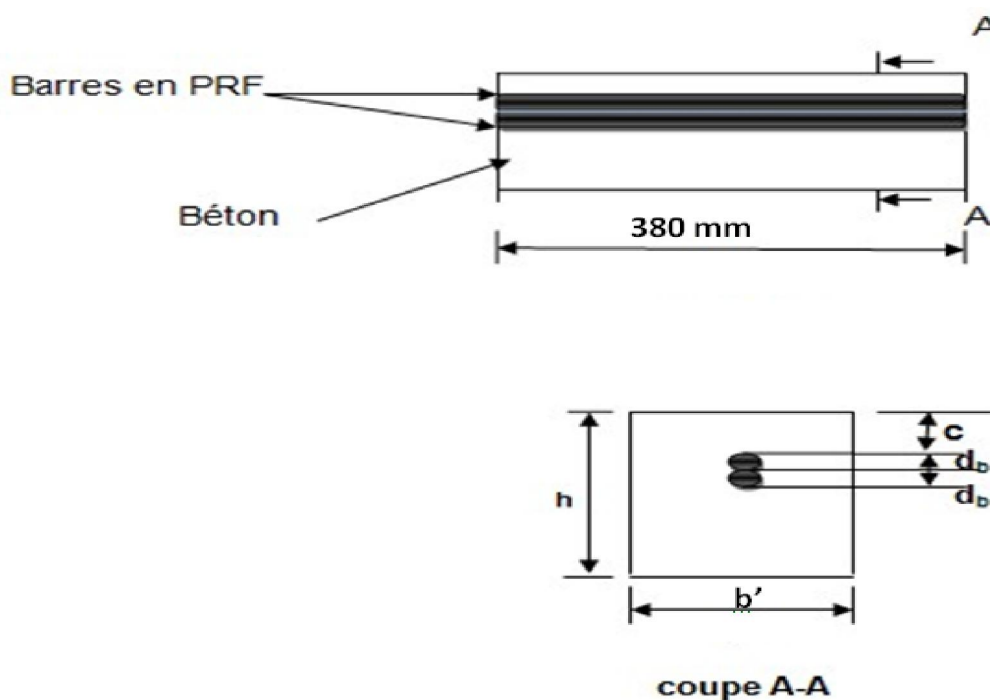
Poutre typique en béton armé de deux barres de PRF.
